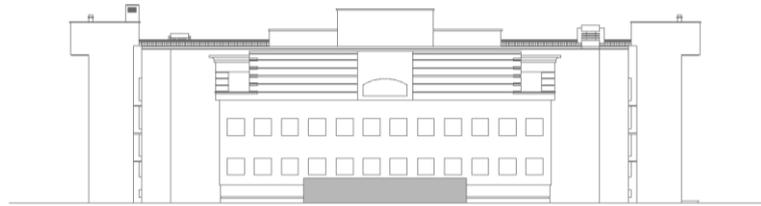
Fachada Oeste. Elaboración propia basada en planimetría aportada.
